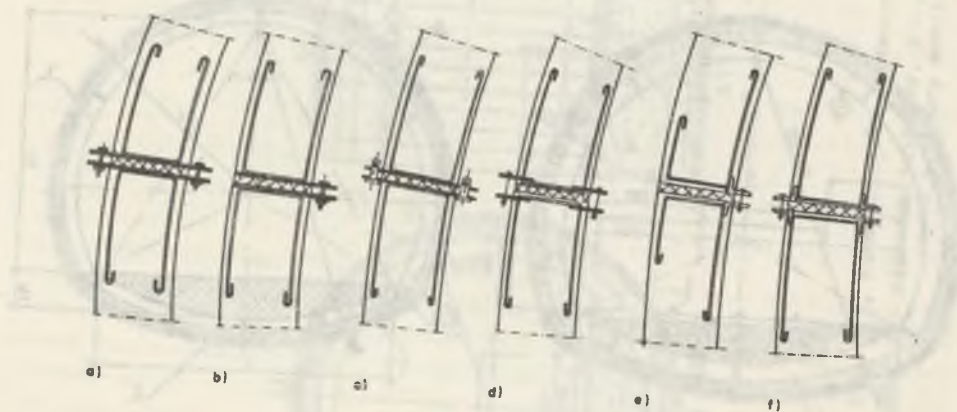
Konstrukcja 5-segmentowej obudowy żelbetowej o kształcie owalnym
